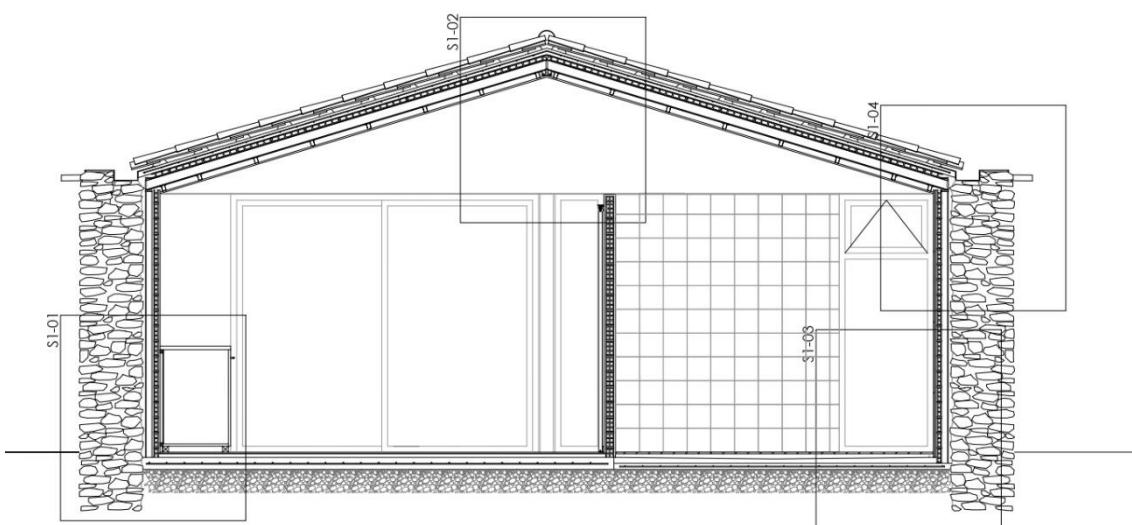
Sección constructiva (solución proyecto básico) [DMP Arquitectural]
